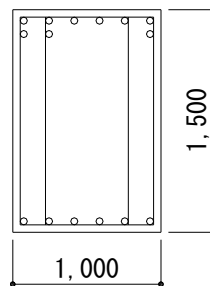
鉄筋コンクリート大梁の配筋図 (1階, B通り, 2～3通り間) (単位：mm)
